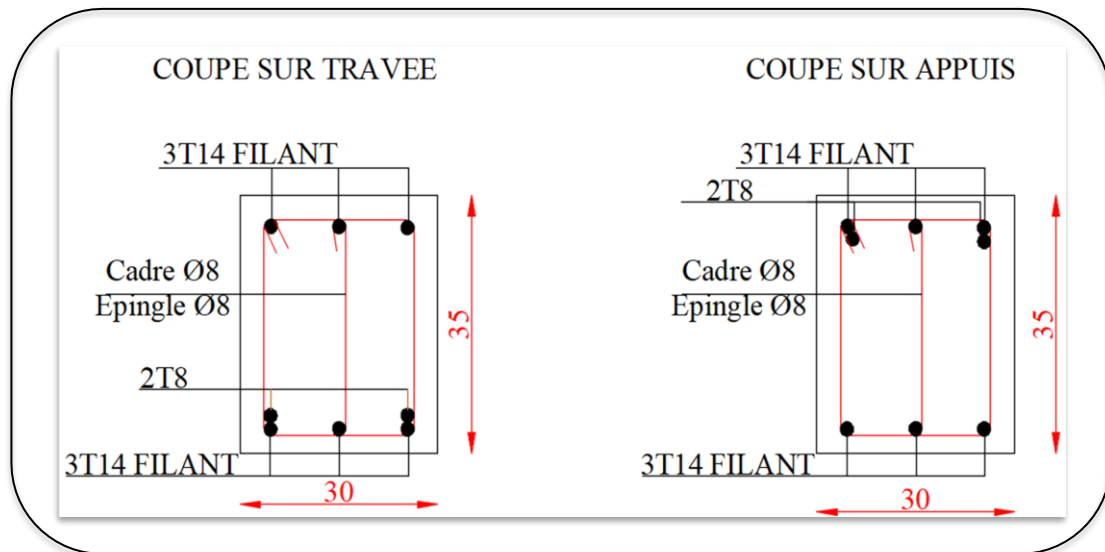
Schéma du ferrailage de la poutre palière.
